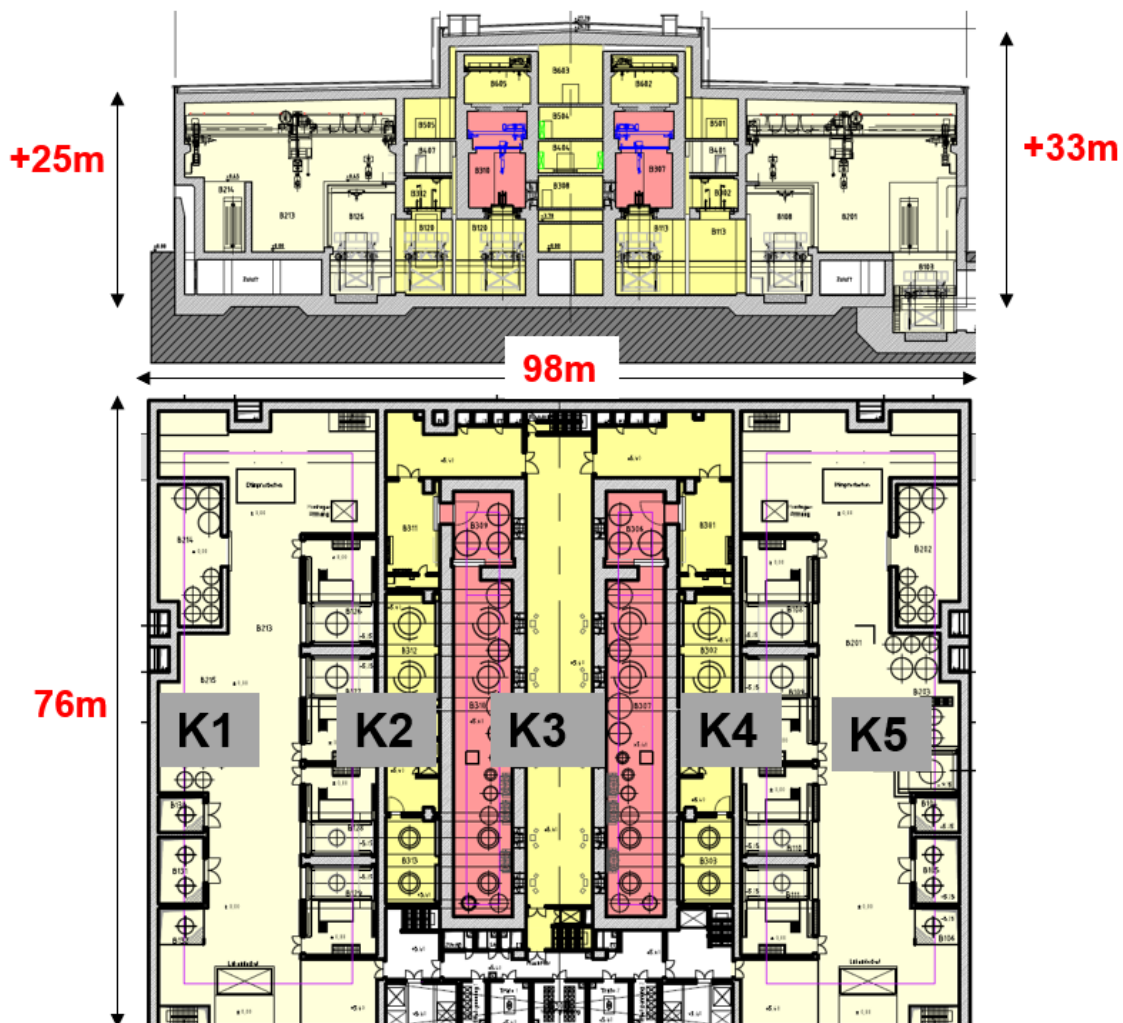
BEVA Übertag im Schnitt und Grundriss mit den Prozessen K1 bis K5
